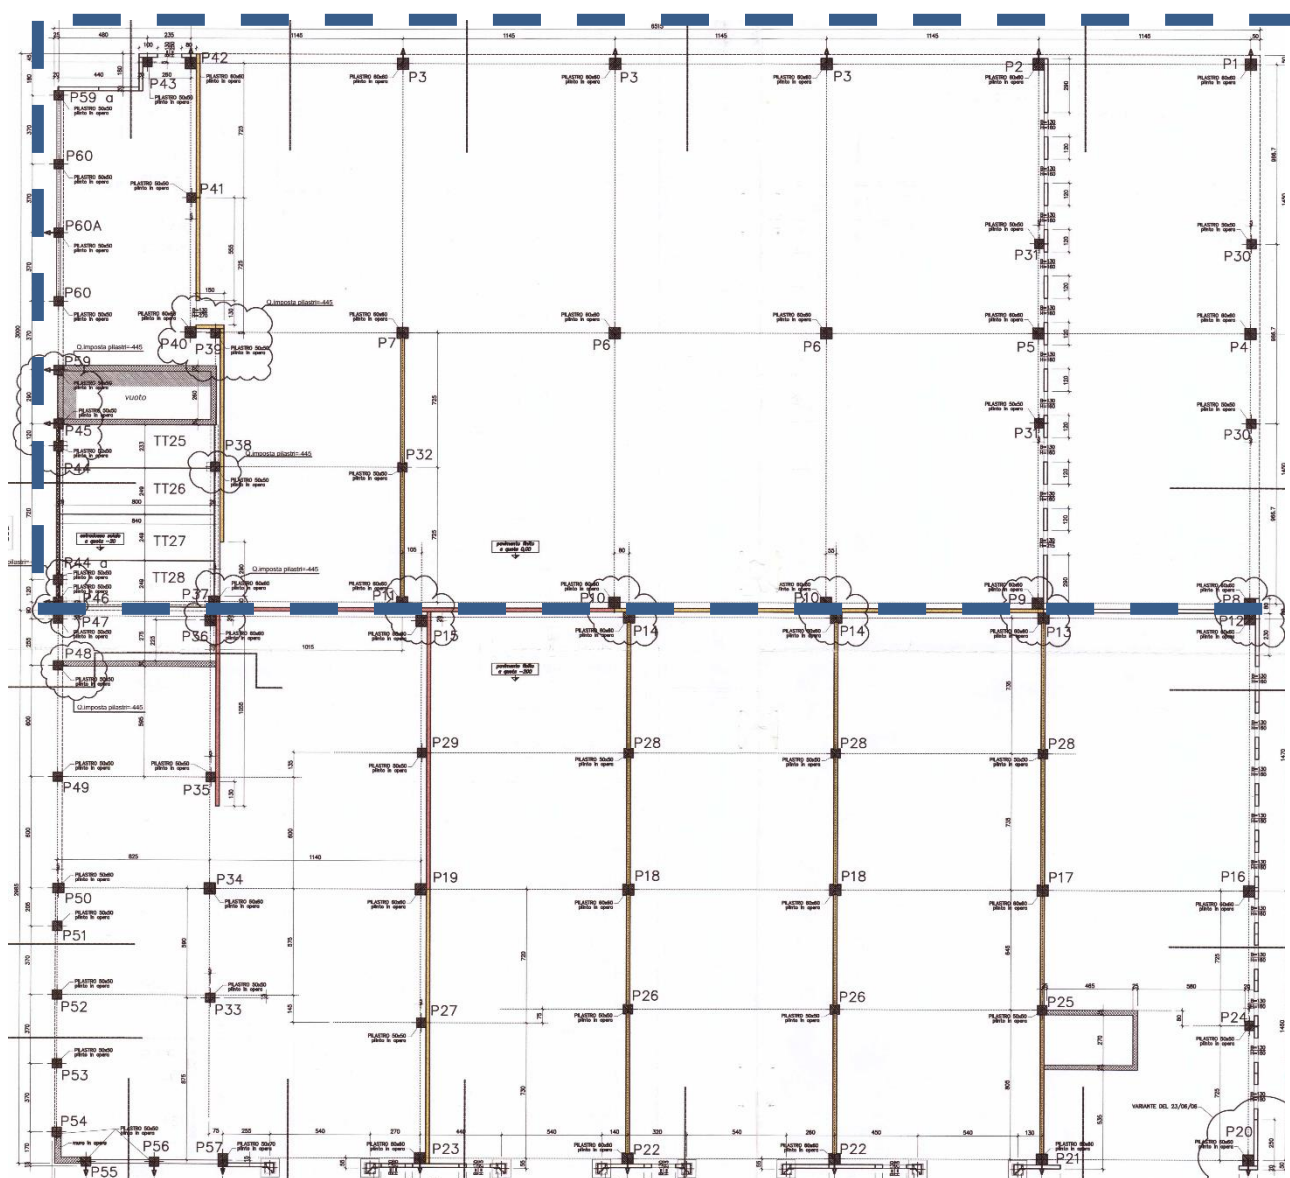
Pianta dei pilastri dell'intero complesso artigianale (l'area di intervento è rappresentata dalla porzione superiore riquadrata)
